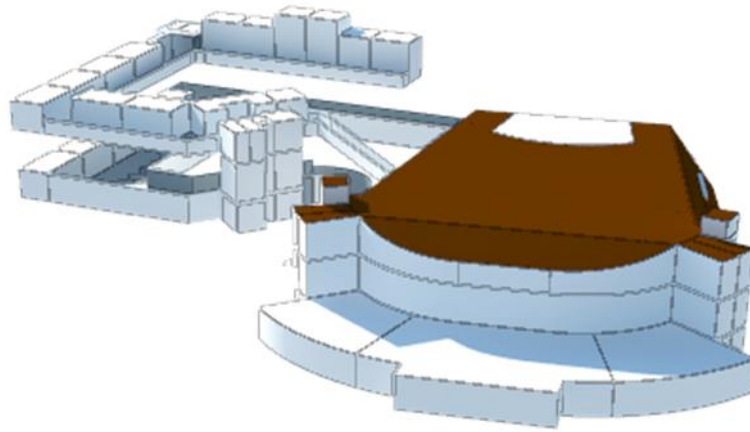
Denah Skematik *Lantai 2 Gedung Pertunjukan.
